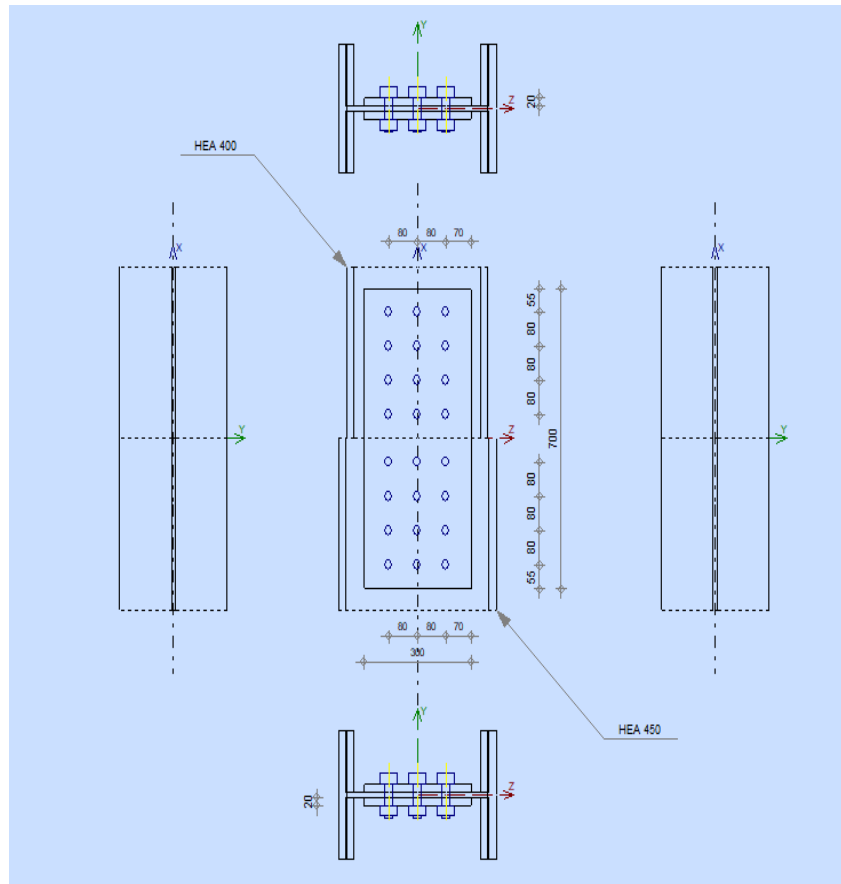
ASSEMBLAGE HEA450-HEA400
